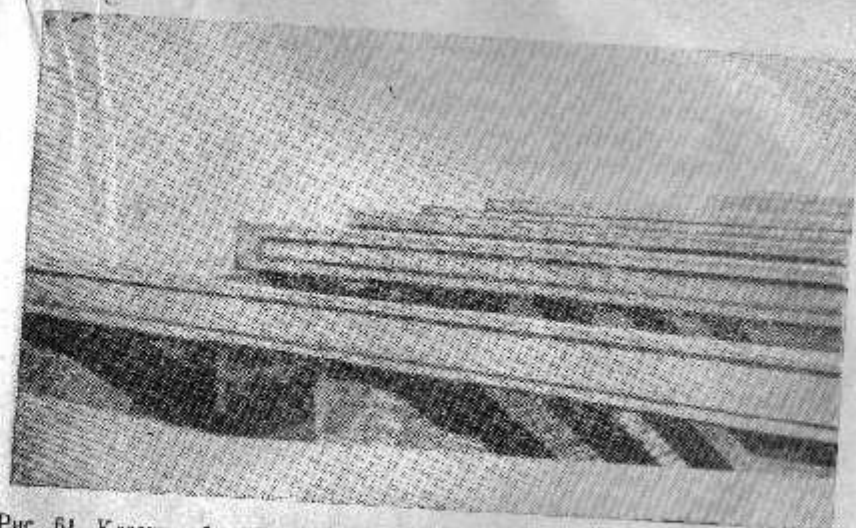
Клееные балки междуэтажного перекрытия жилого дома в Автове (Ленинград)
